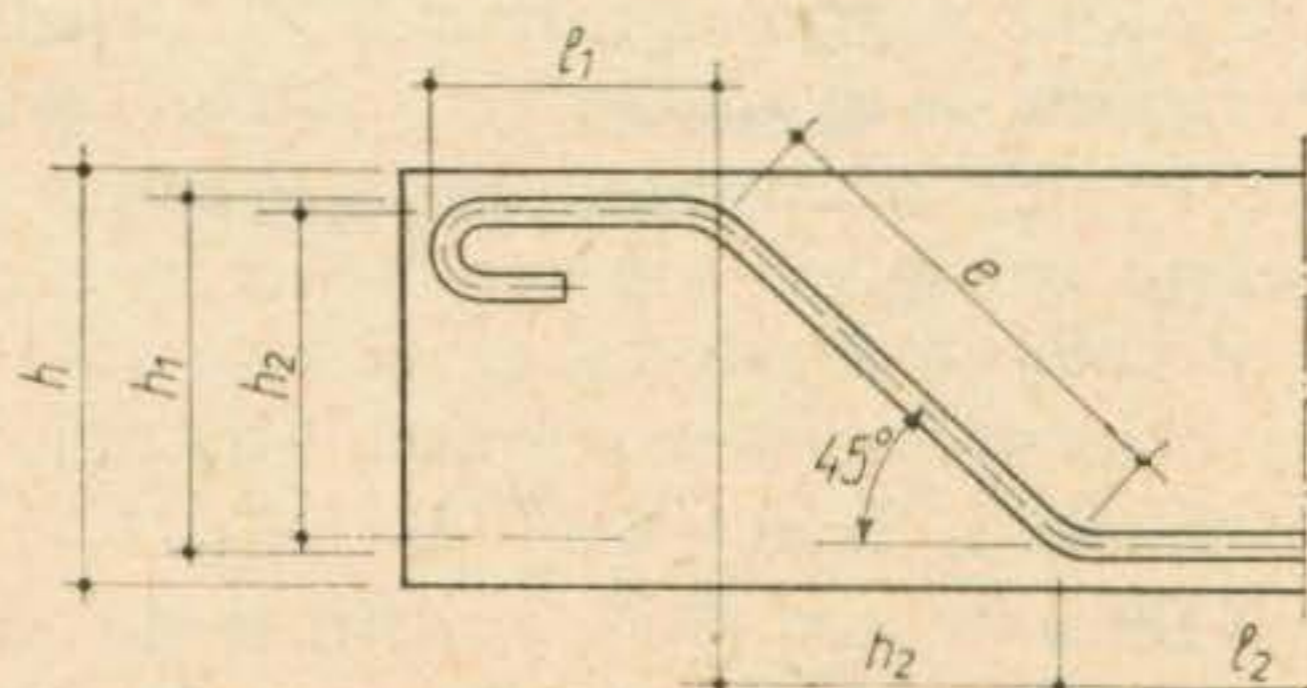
Determinarea lungimii segmentelor barelor de oțel-beton.
